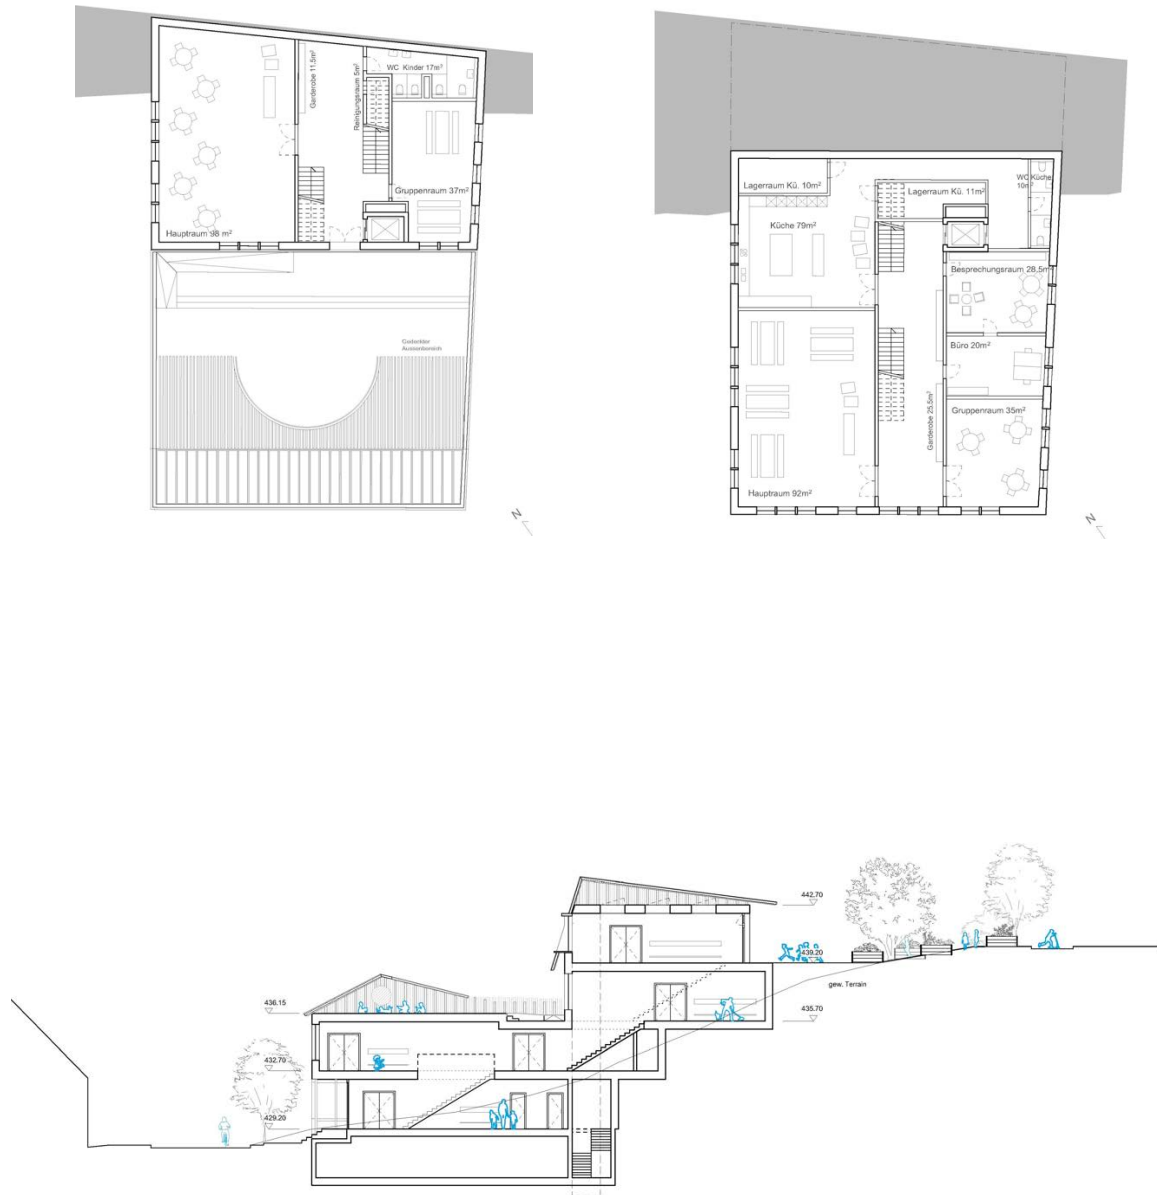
Grundrisse und Schnitt (v. o. l. n. u. r.)
